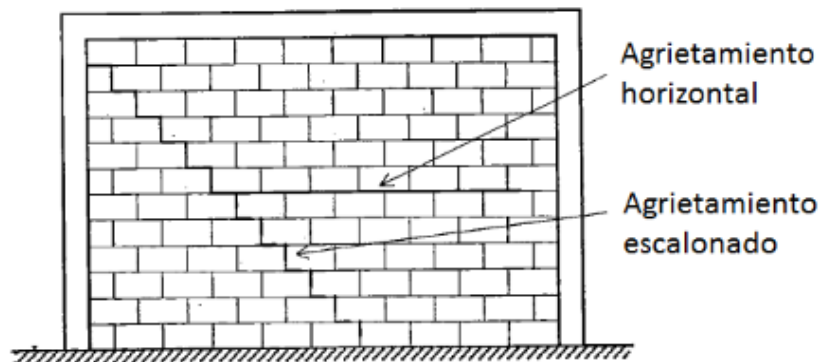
Agrietamiento escalonado y horizontal de la pared de mampostería
